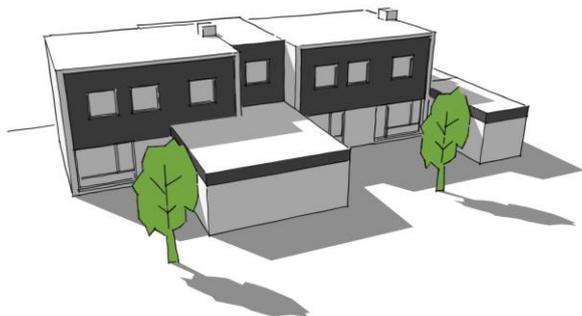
Erweiterungsmöglichkeit Haustyp 5 mit zwei- und eingeschossigen Anbauten, eigene Darstellung
